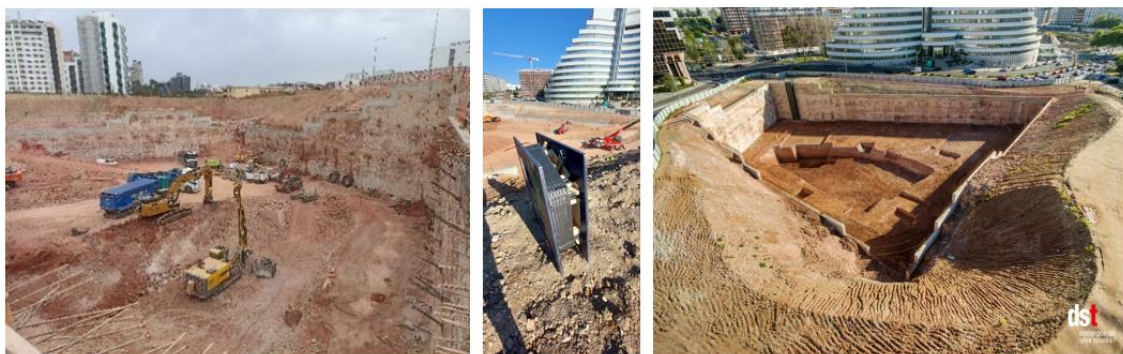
a) Vista da obra em fase final dos trabalhos de escavação. b) inclinómetro automatizado ShapeArray em bobine antes da sua instalação. c) escavação finalizada
